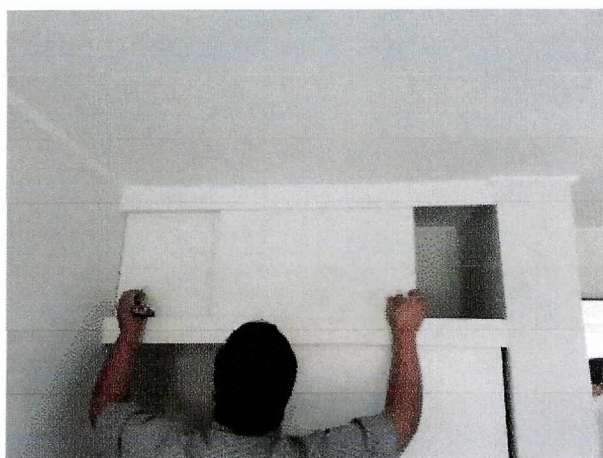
Vista superior de muro con encuentro de cielo.
